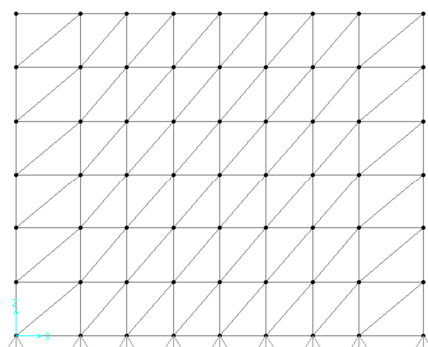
Configuração dos Planos de Contraventamento Vertical Com Elementos de Contraventamento Pequenos
